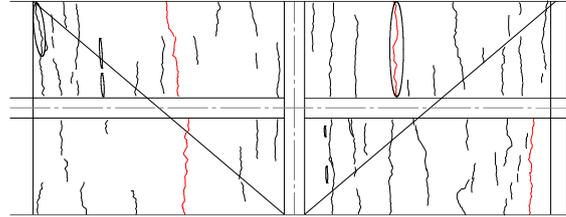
4K カメラ近接撮影法によるひび割れ図
